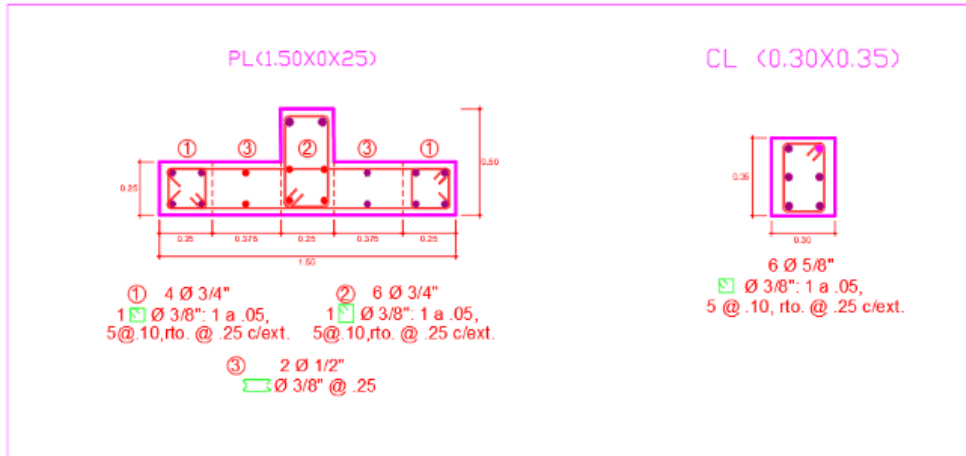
Detalle de la Placa y columna dimensionadas para el refuerzo.
